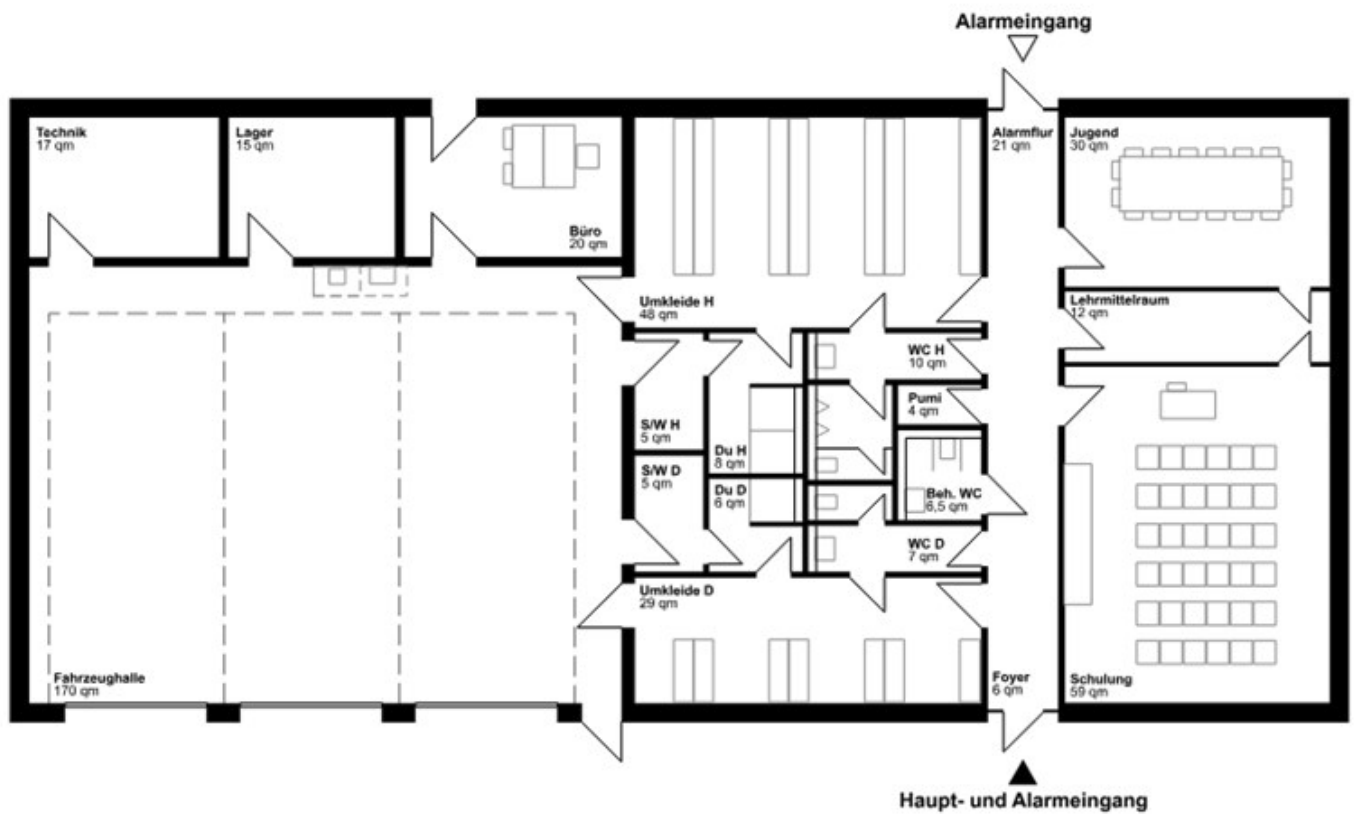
Musterraumprogramm 3 Stellplätze eingeschossig, Grundrissplan
